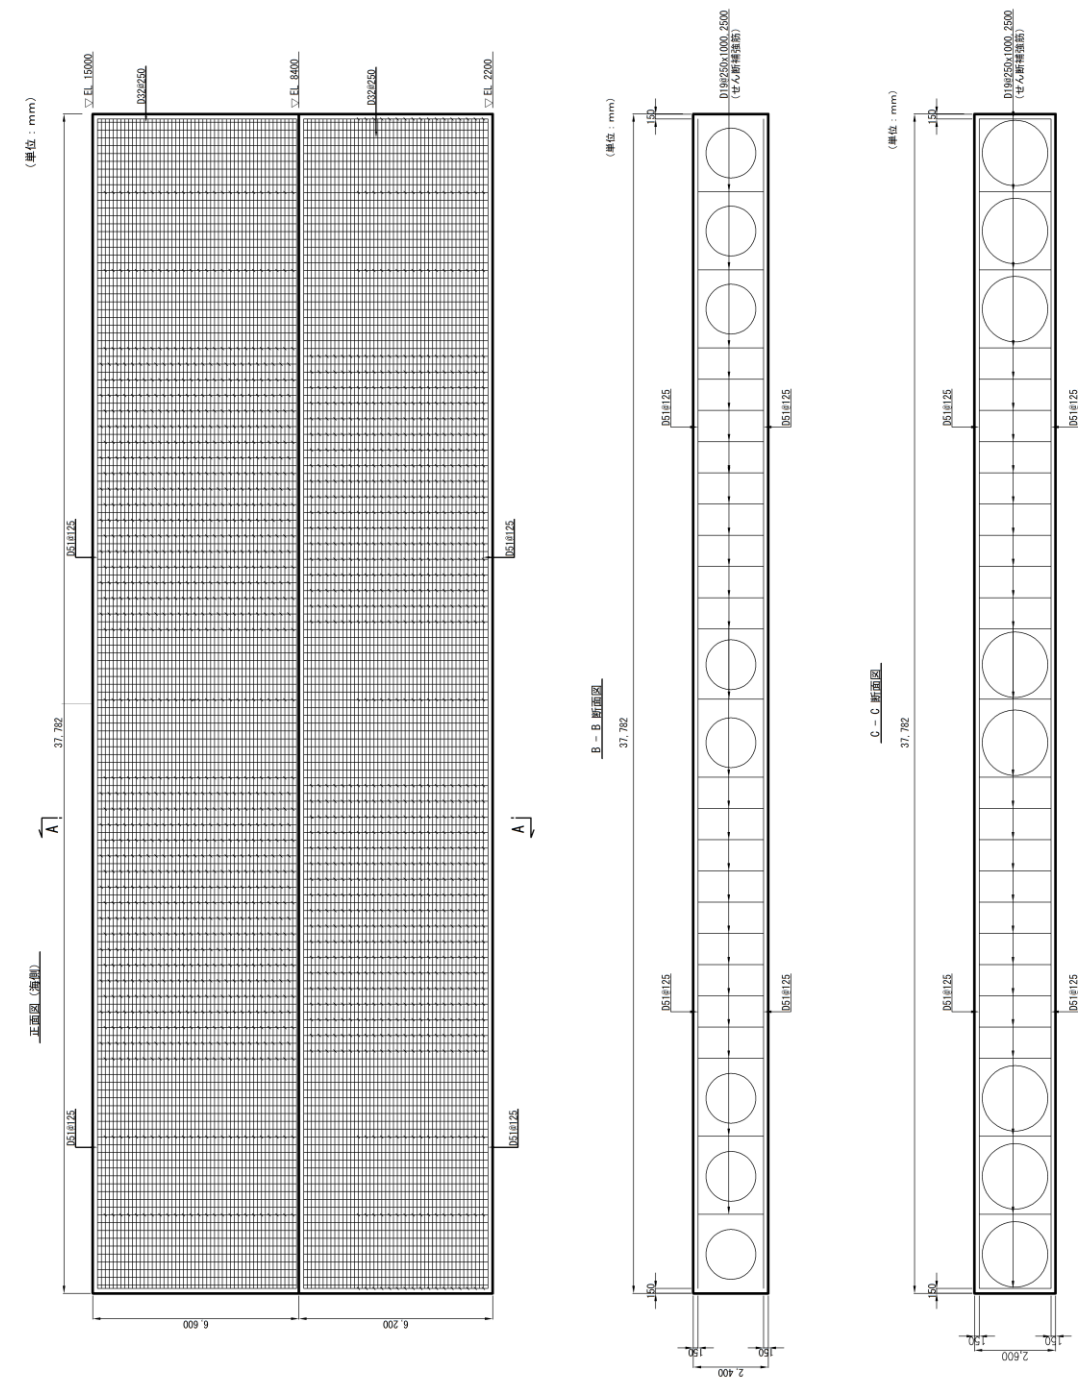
被覆コンクリート壁の概略配筋図 (④-④断面)
